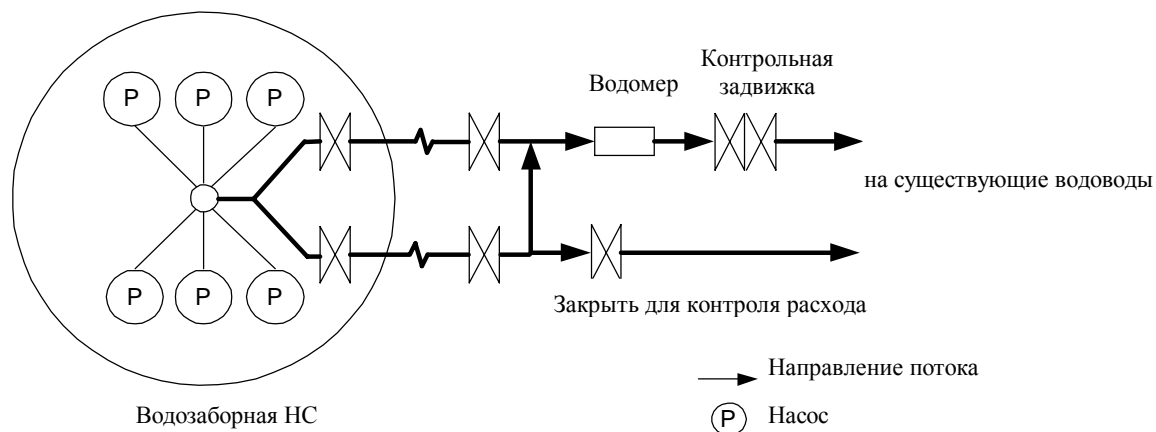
Соединение Н.С. первого подъема и соединительного трубопровода
